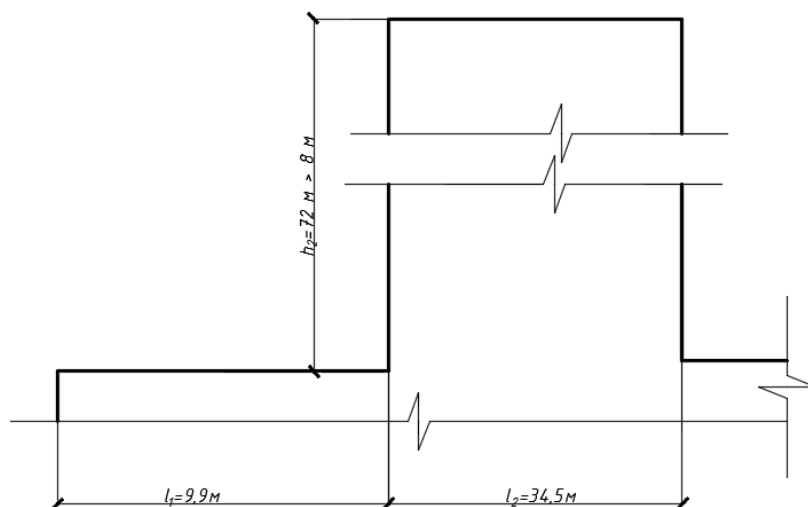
К расчету снеговой нагрузки на покрытие в зоне стилобатных частей
